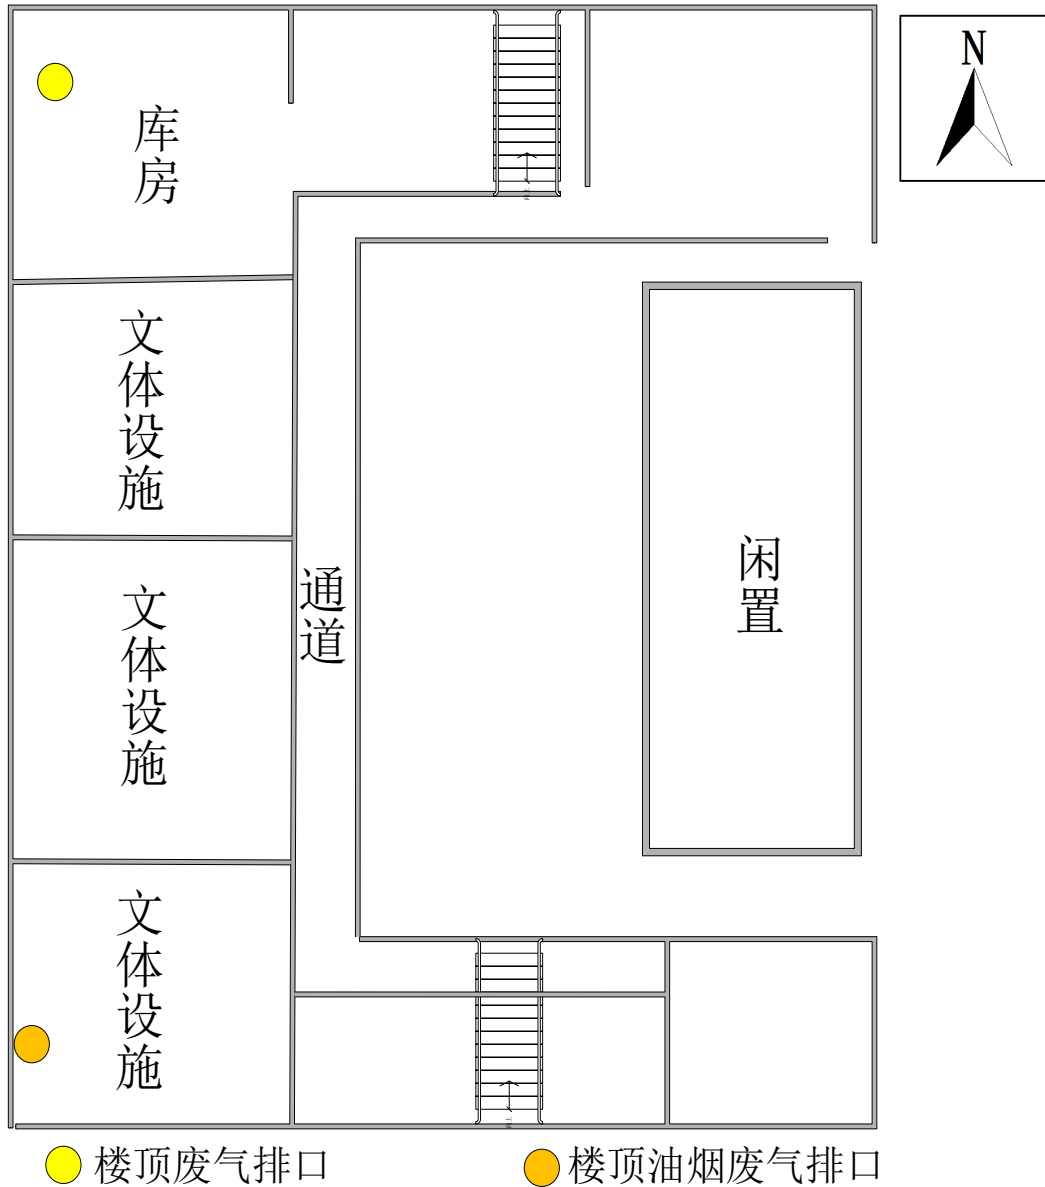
项目平面布置图（地上 2、3 层平面布置图）
